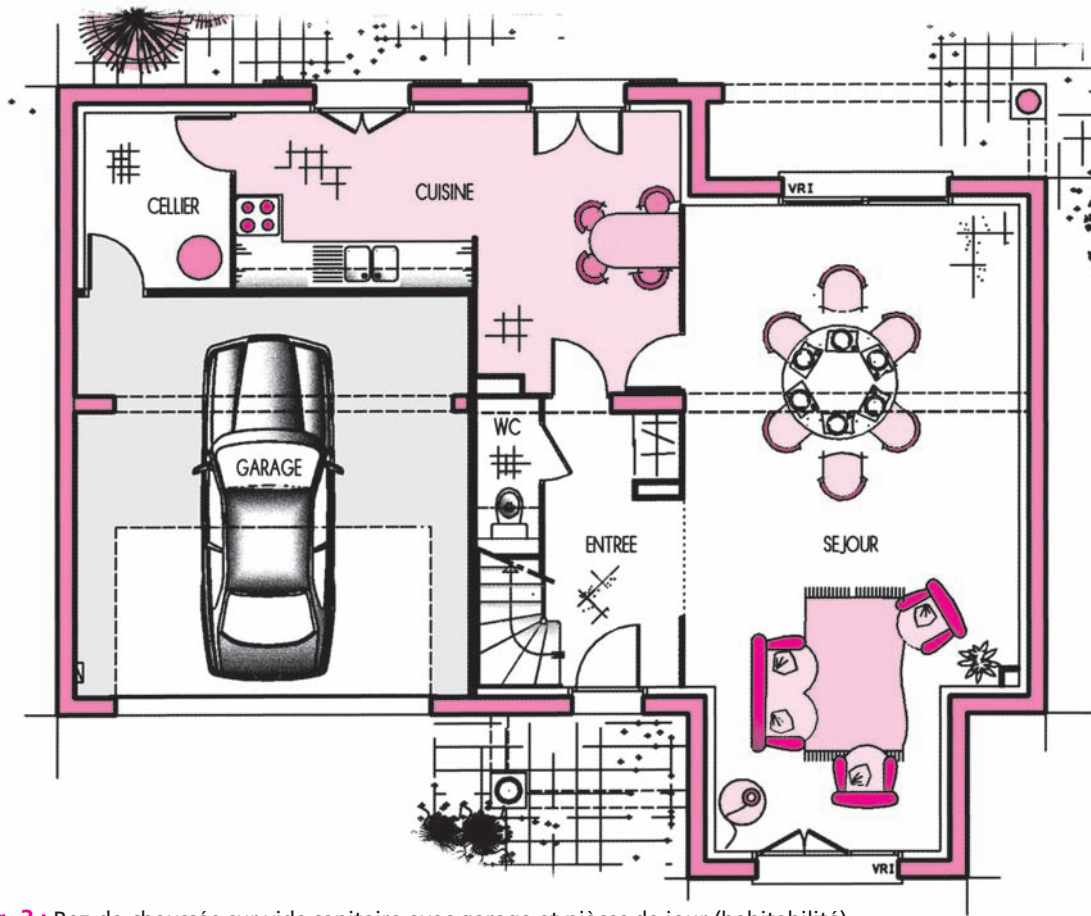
Rez-de-chaussée sur vide sanitaire avec garage et pièces de jour (habitabilité)
